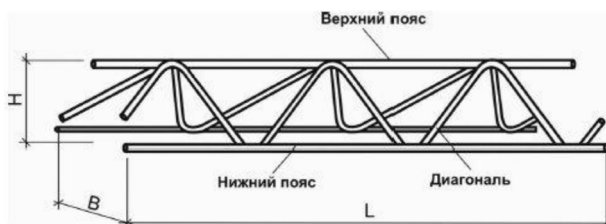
Схема пространственного арматурного каркаса железобетонных балок
